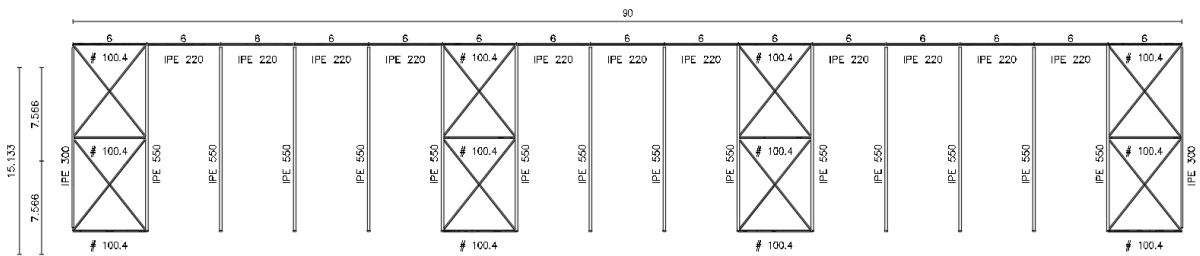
Viga contraviento en plano de faldón (CYPE)
